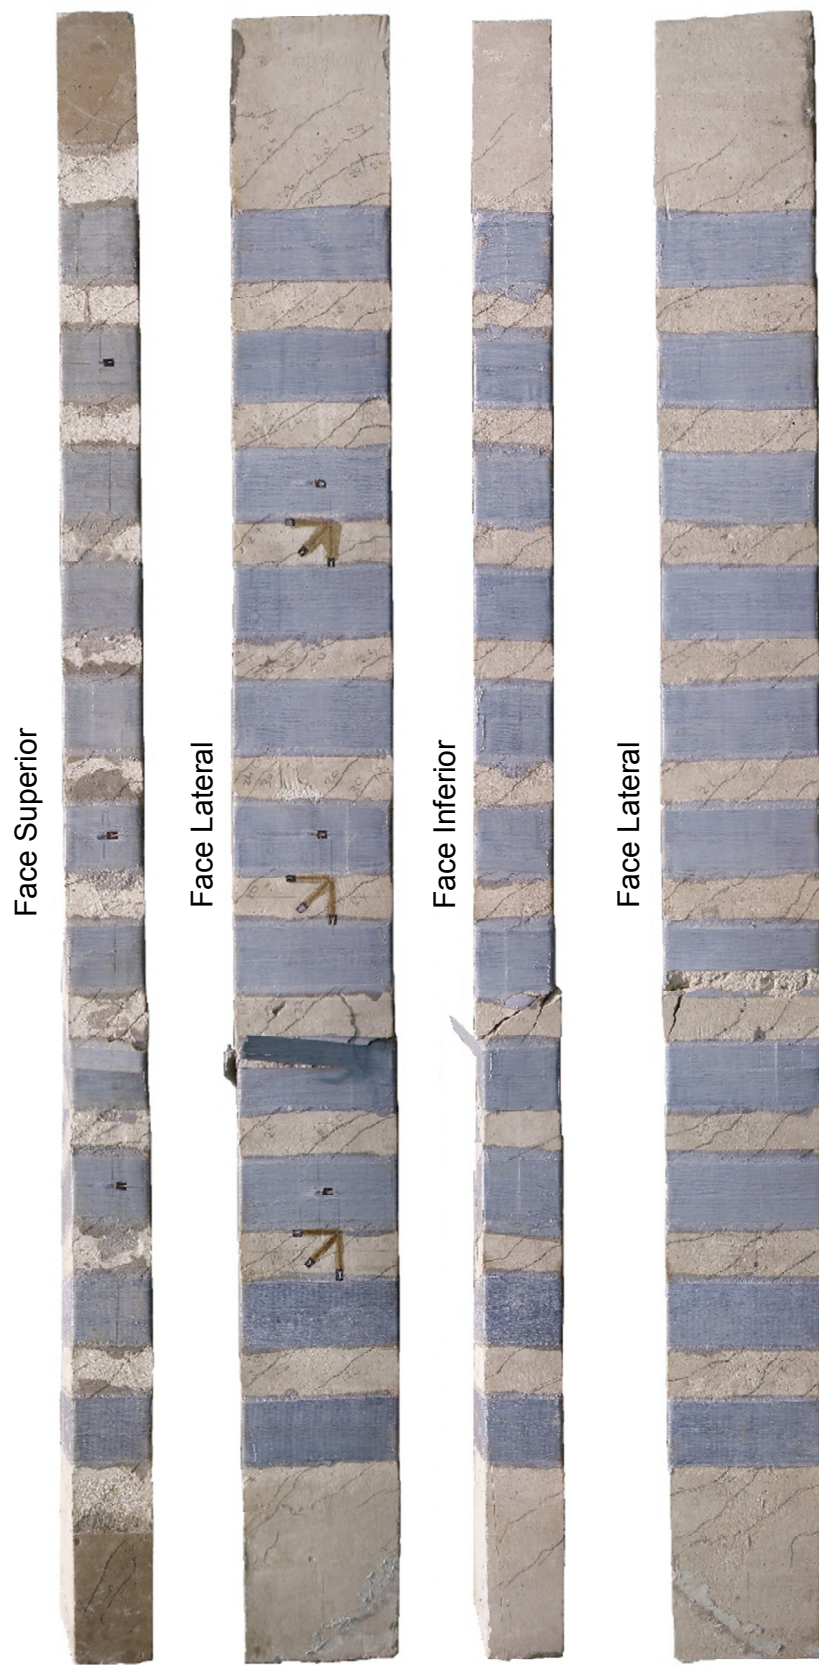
Configuração das fissuras da viga VT3.
